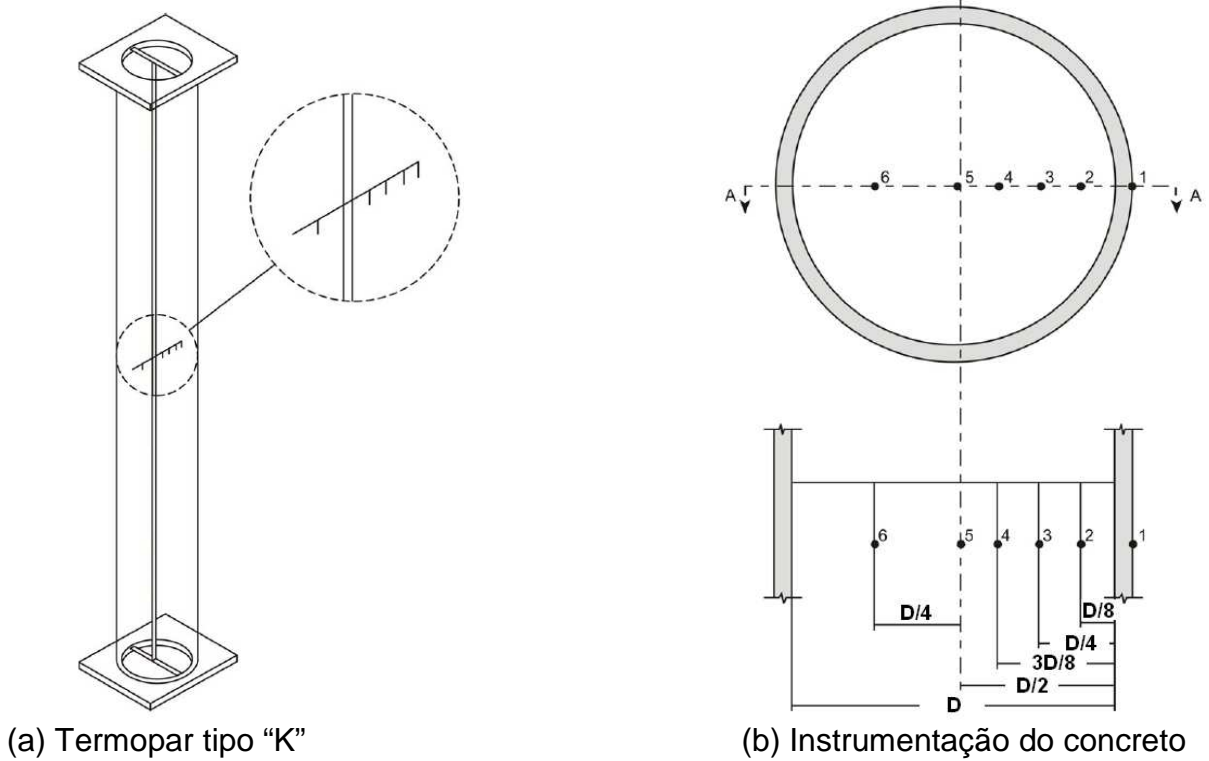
Termopar tipo "K" e instrumentação interna da coluna
